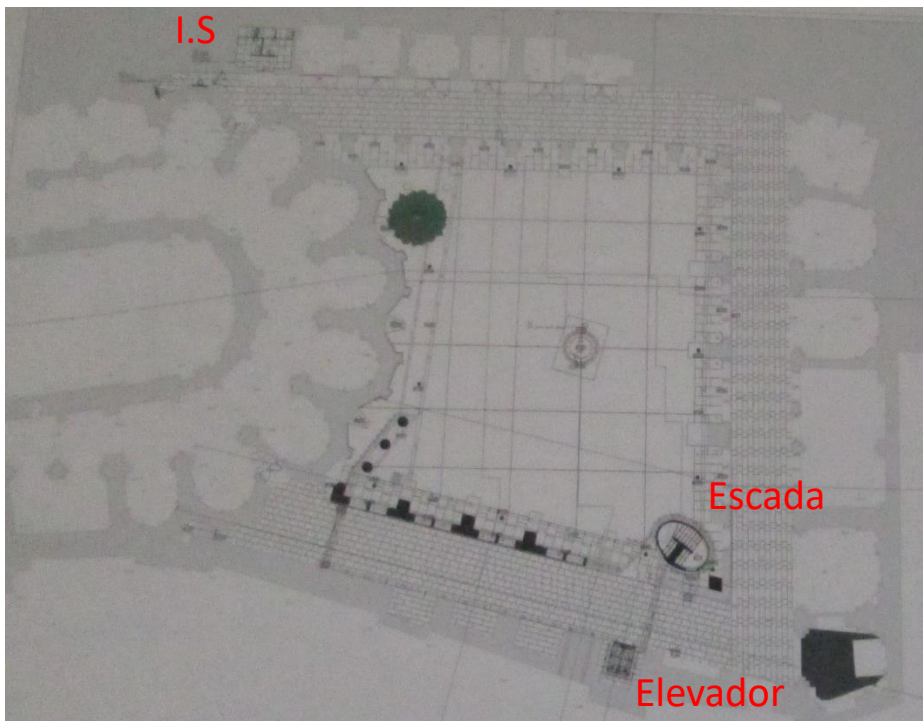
Piso 0. Muro desmontado (preto), Instalações sanitárias existente no piso 0. Nova Escada e elevador
